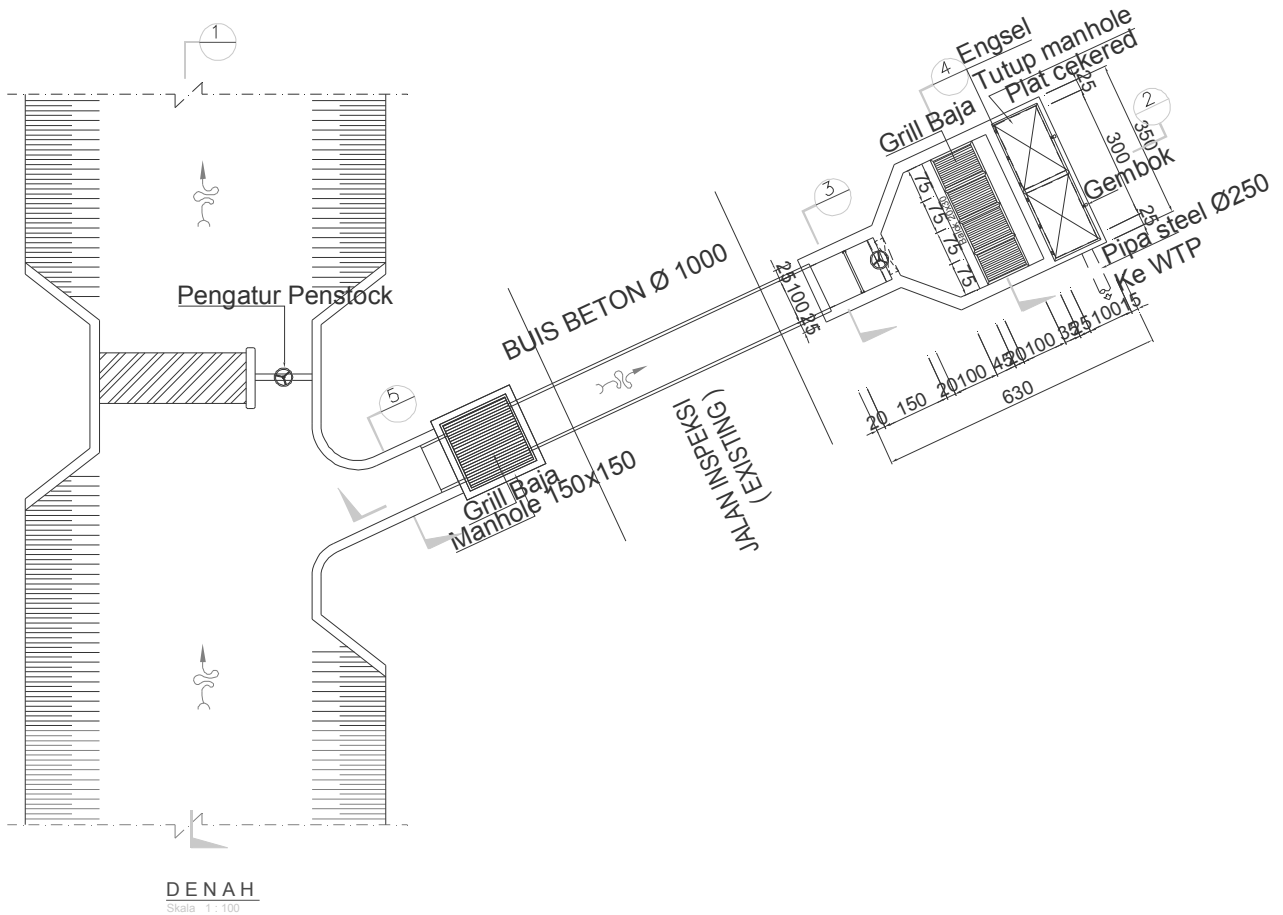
Denah bangunan pengambilan bebas tanpa pintu air
